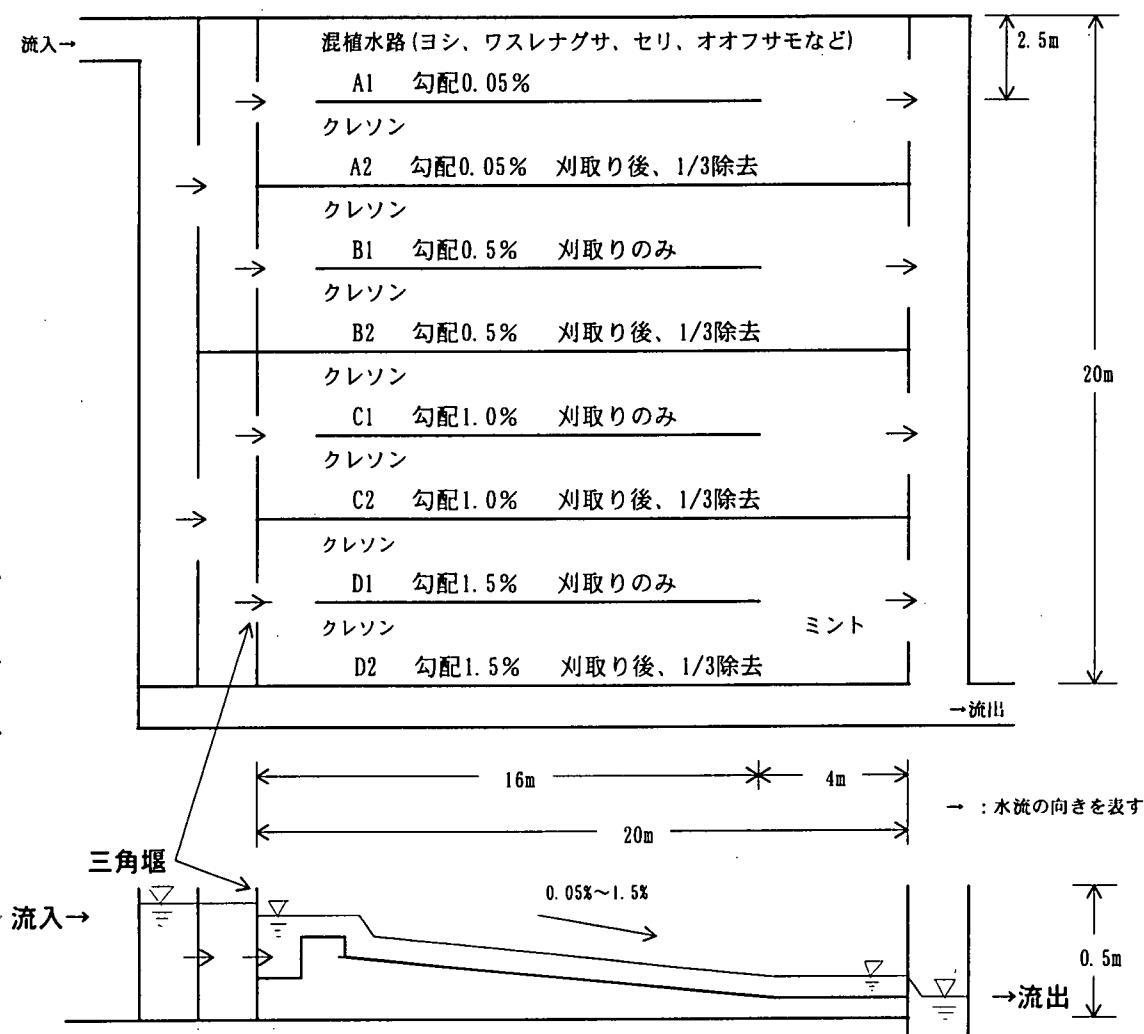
浅池型植生浄化施設の概要図（上段：平面図、下段：断面図）
